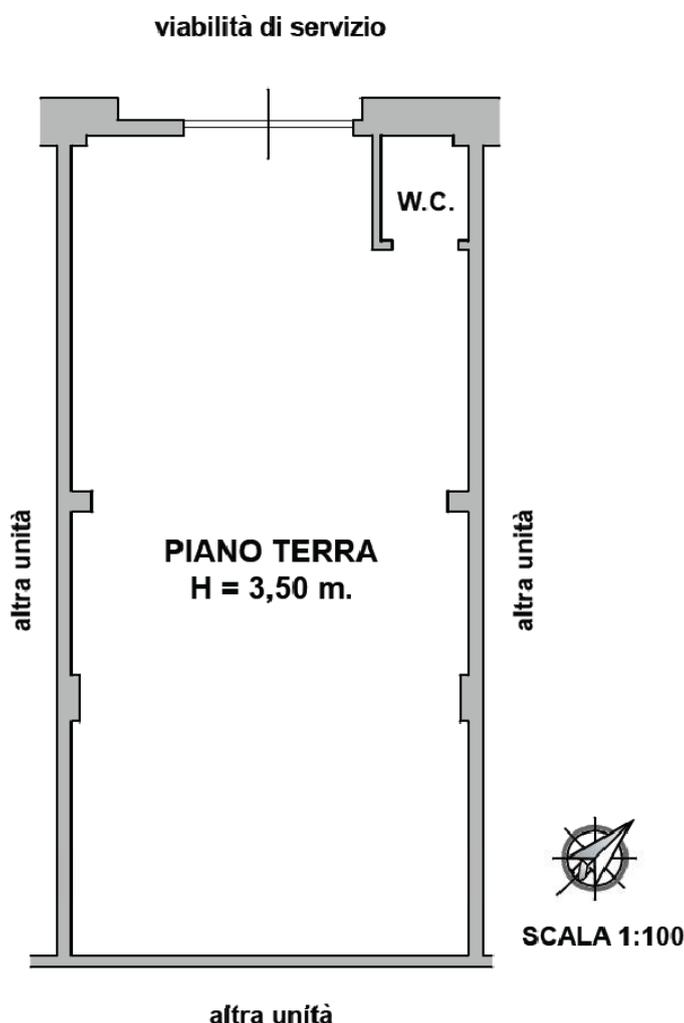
LOTTO 3 - Planimetria laboratorio artigianale foglio 76 - part. 620 - sub. 33
